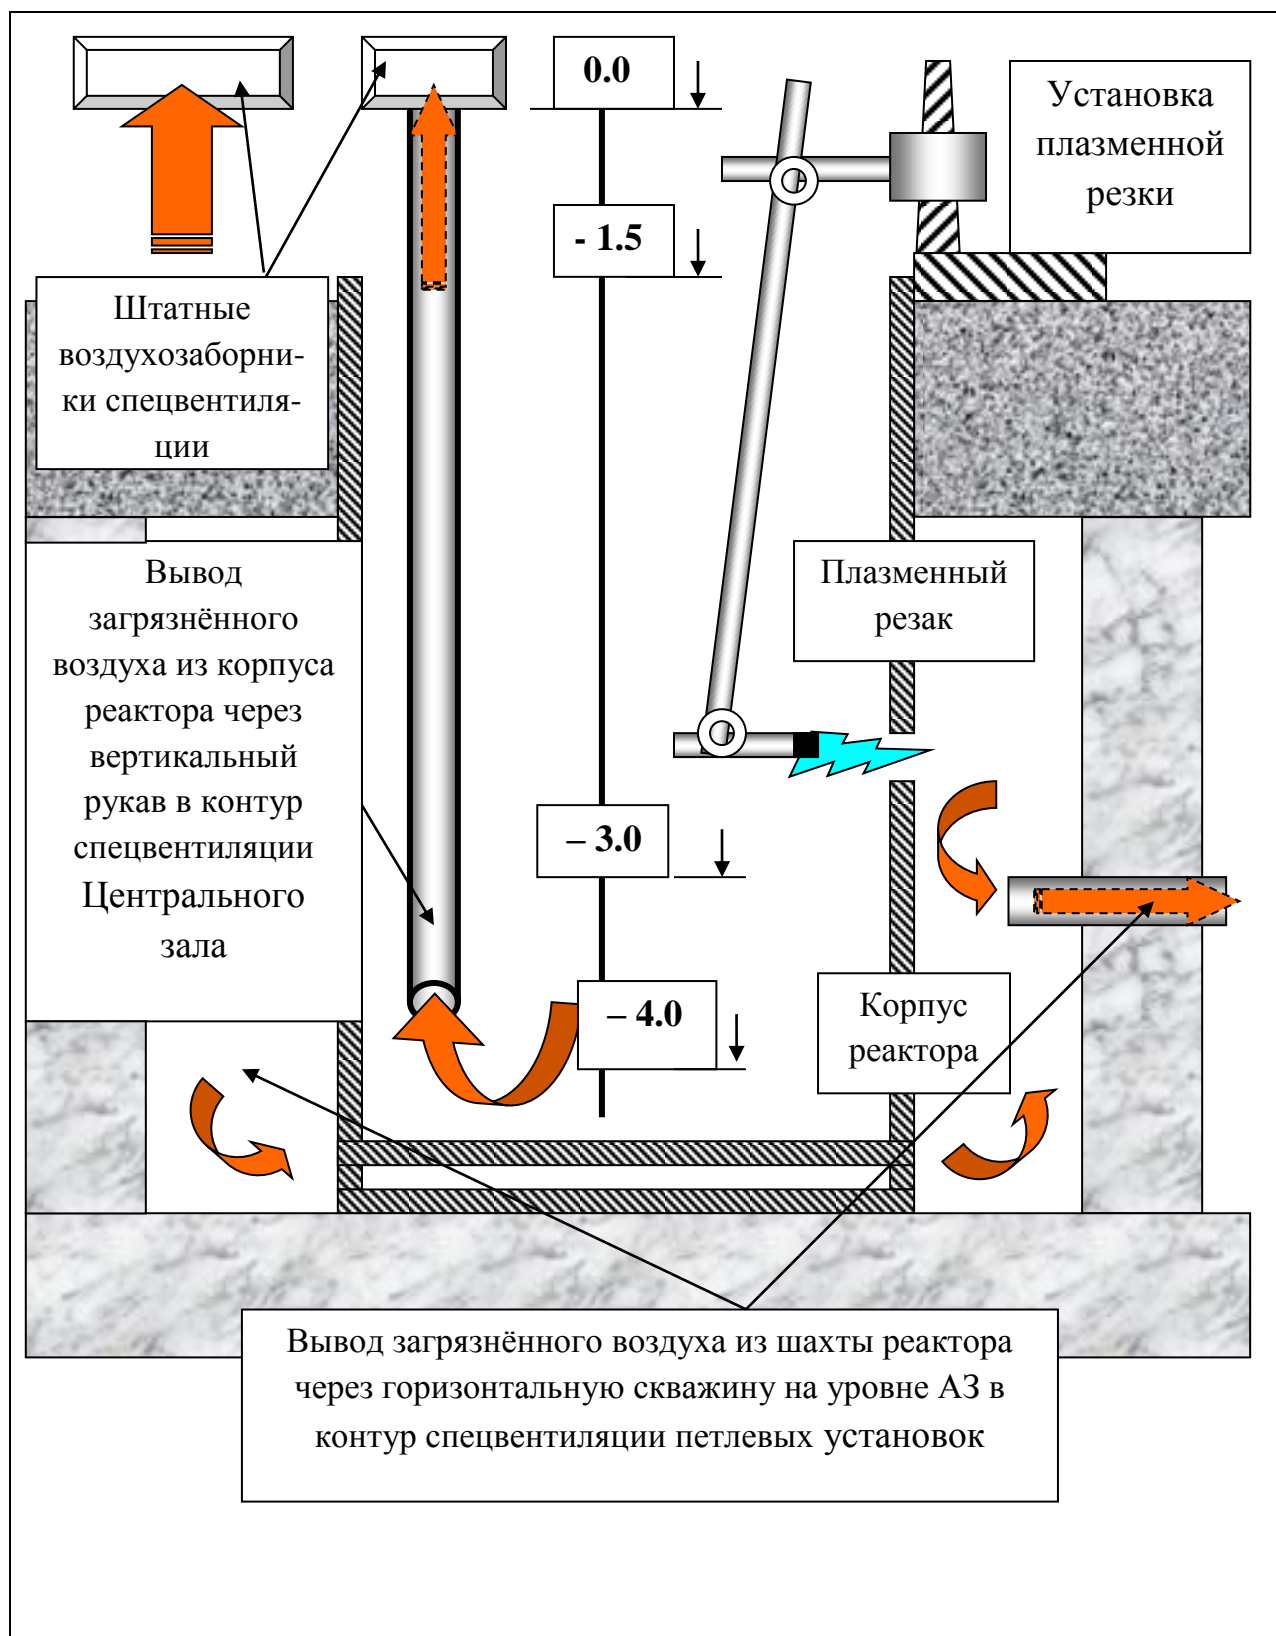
Схема вентиляции при демонтаже корпуса реактора РФТ
